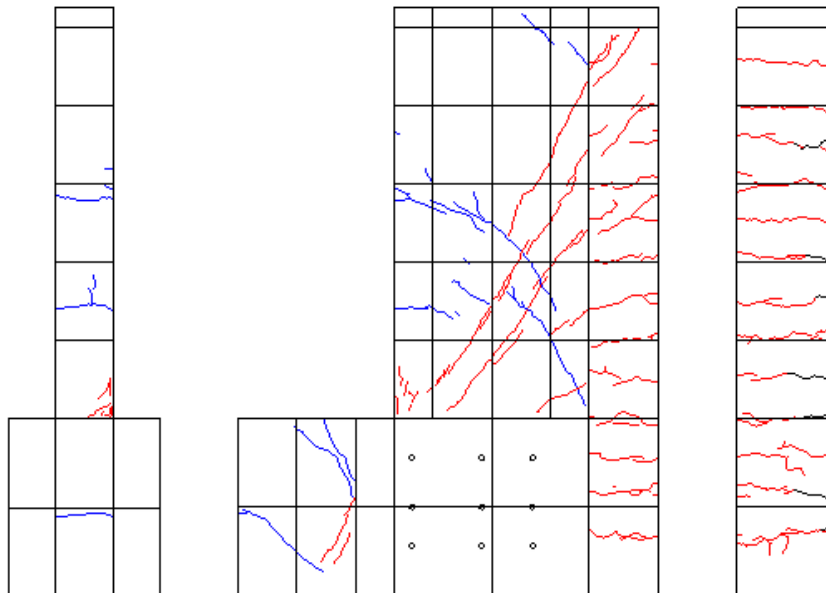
R=-1/10 ひび割れ図
